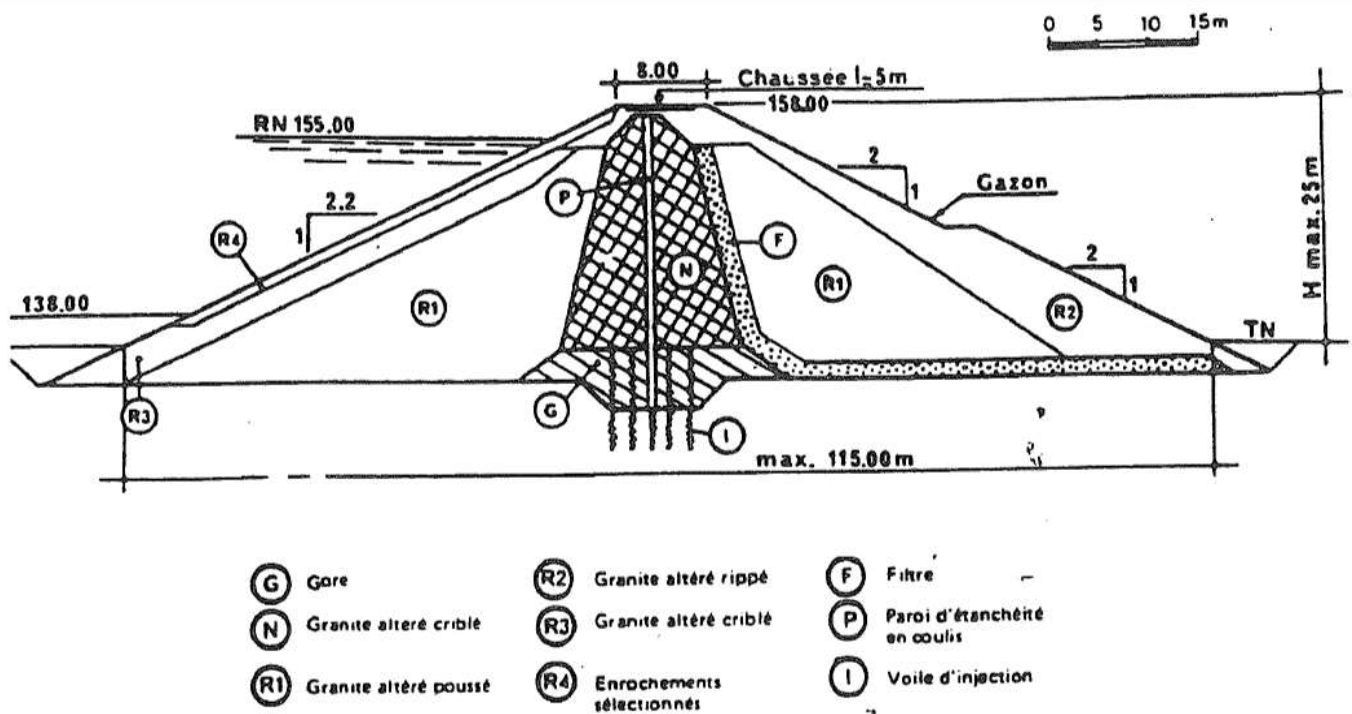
Coupe type du corps du barrage (sce : EPTB Elorn)
